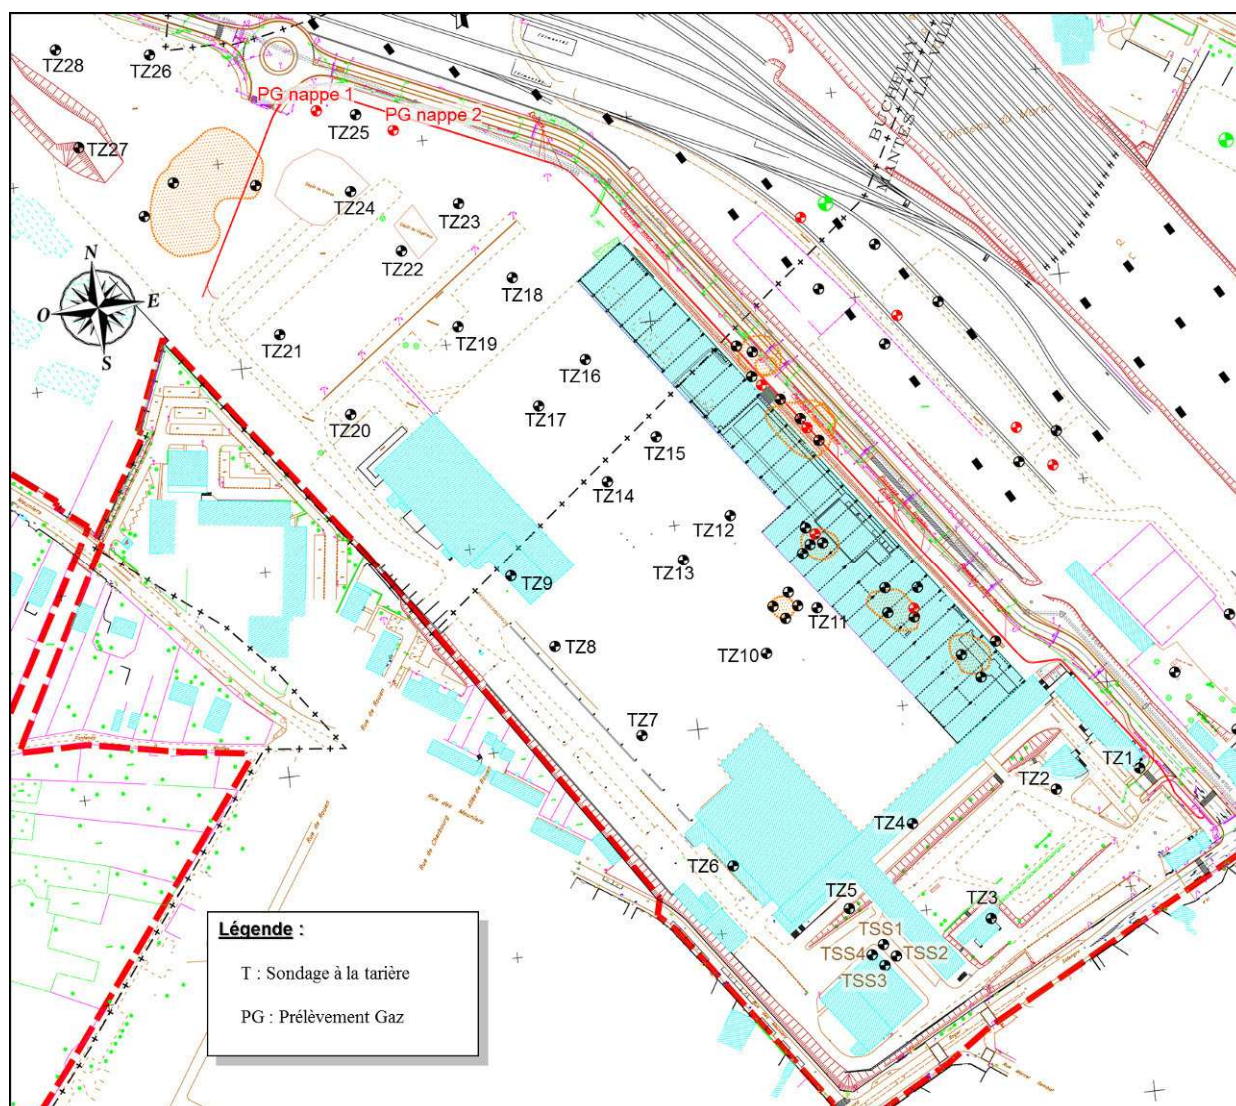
Plan d'implantation de points de reconnaissances sur l'ensemble du site Sulzer et de la station-service
